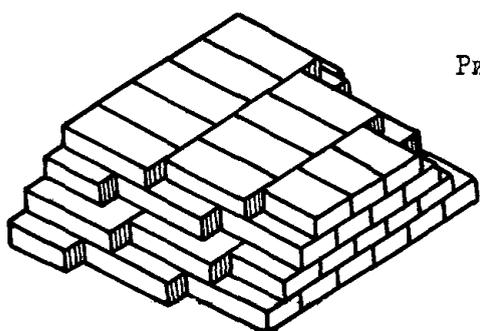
Кладка стен горна из шамотных каолиновых изделий штабой
